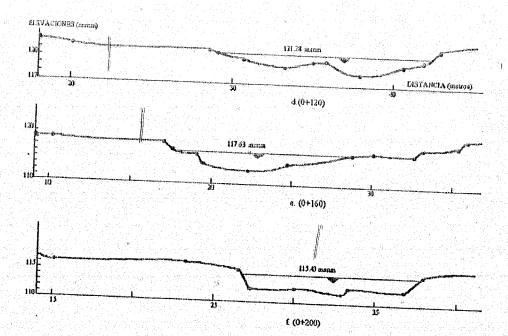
Secciones transversales del arroyo Atolinga, Zacatecas.
